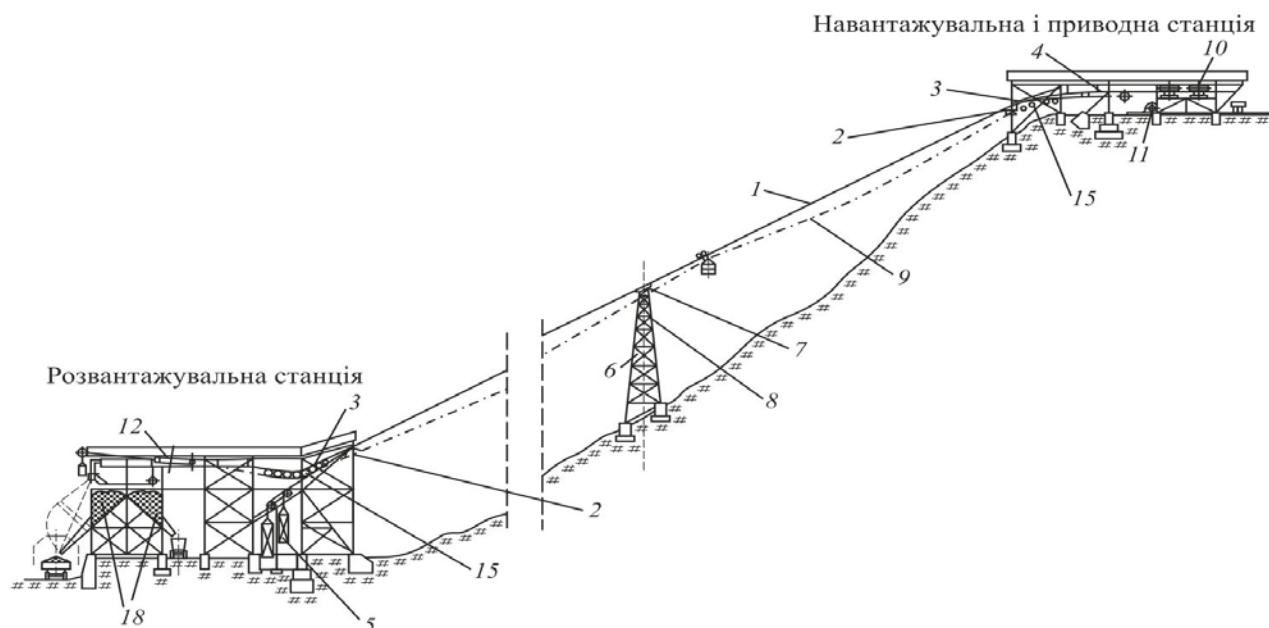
Схема двоканатної дороги: 1 – несучий канат; 2 – відхильний башмак; 3 – рейка; 4 – закріплення несучого каната; 5 – натяжні вантажі несучих канатів; 6 – опора; 7 – опорний башмак; 8 – підтримуючий ролик; 9 – тяговий канат; 10 – привод; 11 – двигун; 12 – натяжний блок тягового каната; 13 – вмикач; 14 – вимикач; 15 – роликова батарея; 16 – пряма стрілка; 17 – крива стрілка; 18 – бункери
